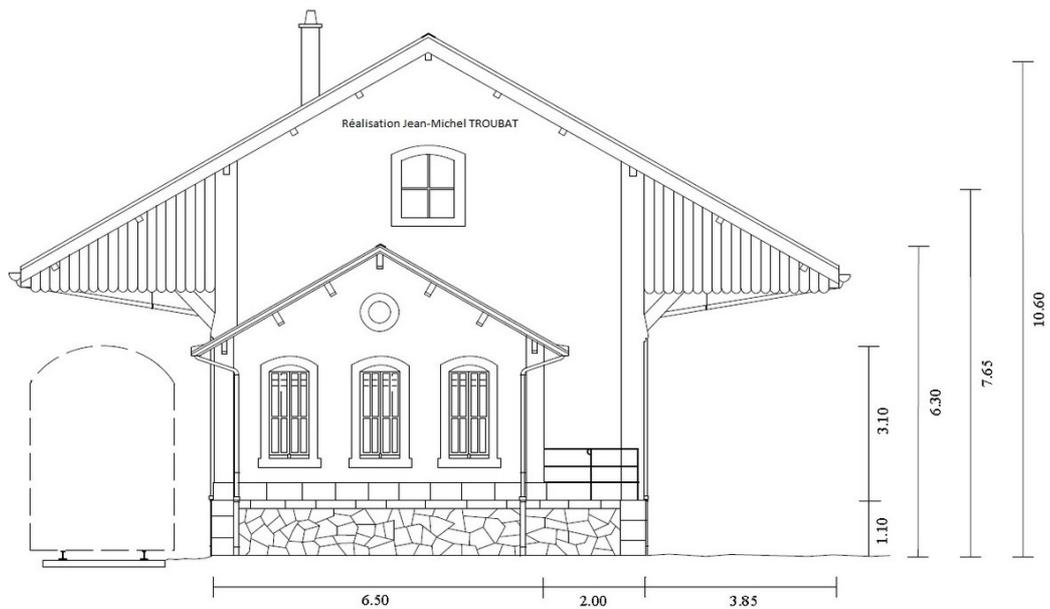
Rilievo del prospetto trasversale della Halle Marchandise della Gare de Bellac. Fonte: www.bellac.gare.over-blog.com, 2015
